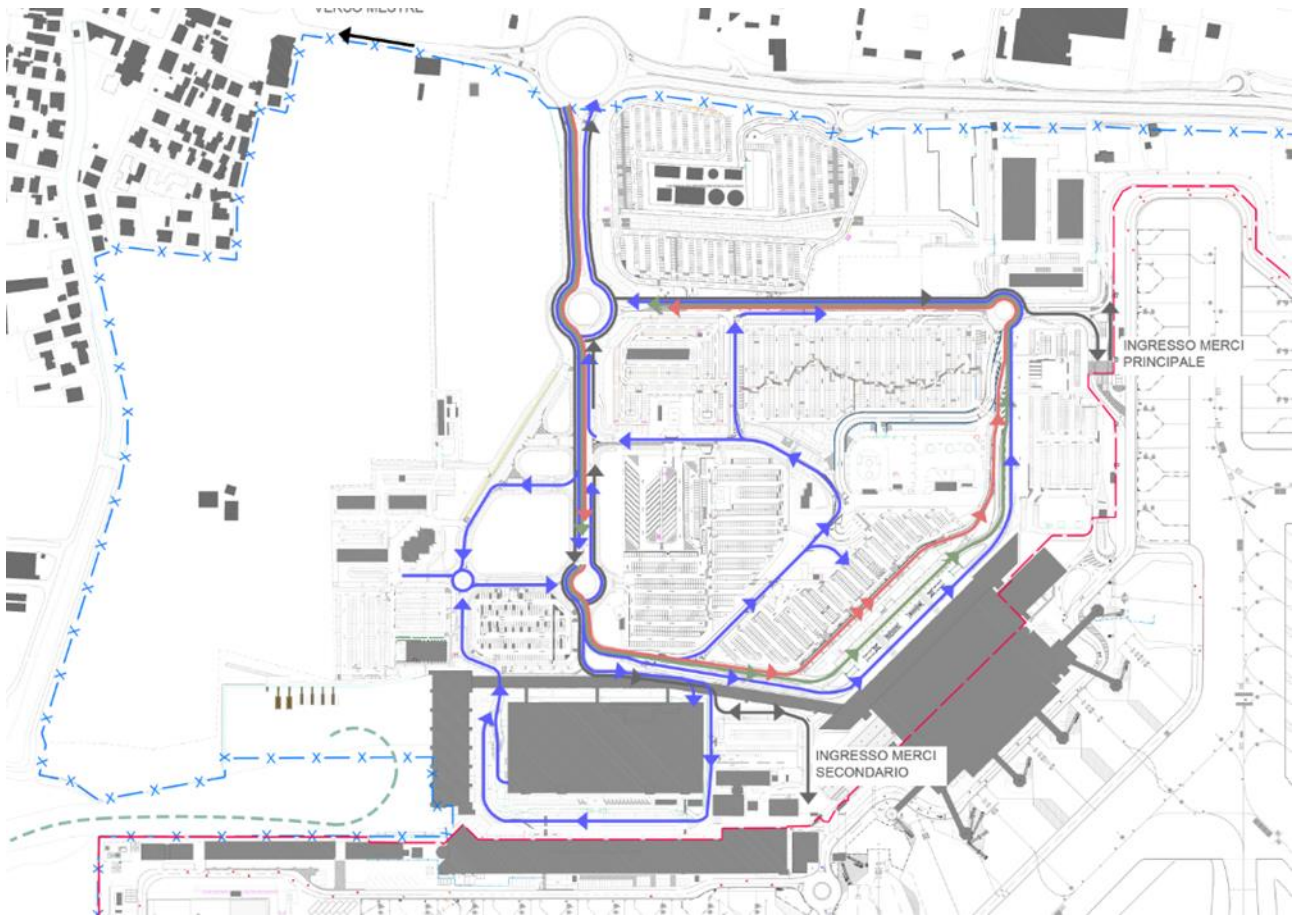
Accessibilità veicolare al 2037 (Estratto da Masterplan Aeroportuale)
